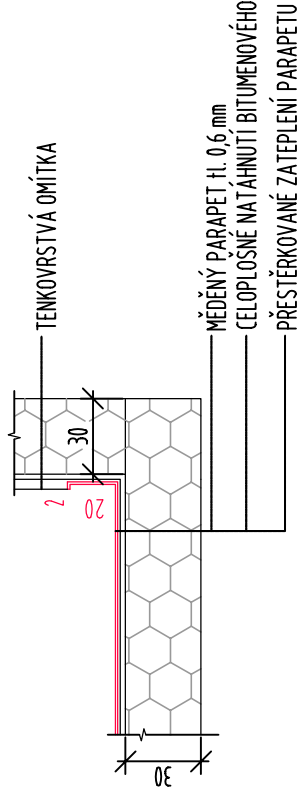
PRINCIP TVORBY DETAILU ZATEPLENÍ PARAPETU M 1:3
